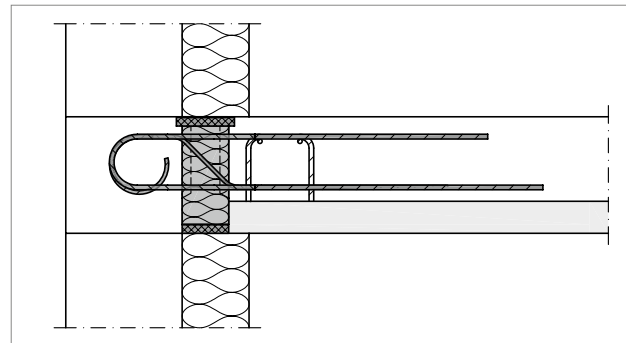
Schöck Rutherma® T type DF : liaison pour façade en béton armé et plancher constitué de prédalles
